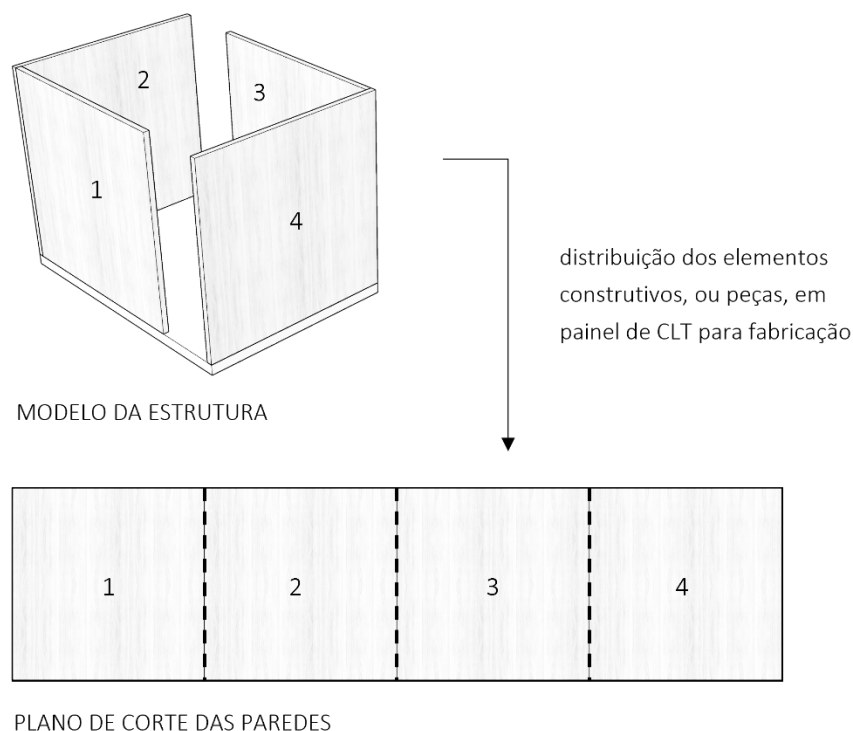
Esquema ilustrando o planejamento do corte de paredes de MLCC.
